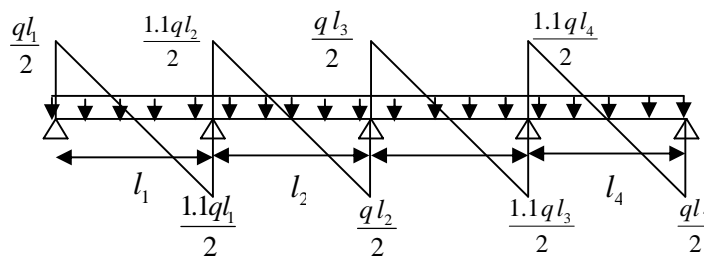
Effort tranchant d'une poutre à plus de 2 travées.
